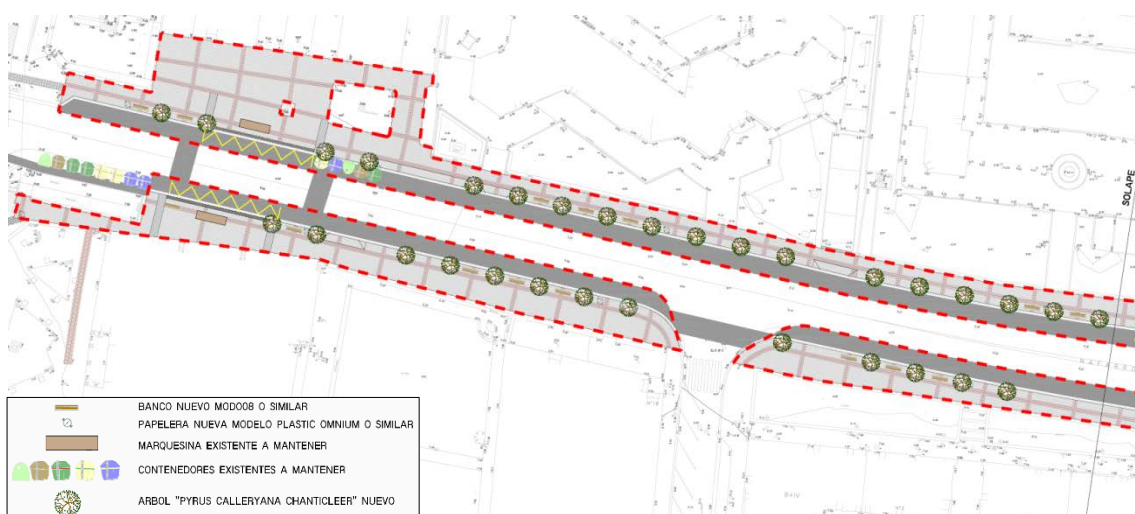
Plano de mobiliario y jardinería de la zona oeste de Nafarroa kalea. 1/2
